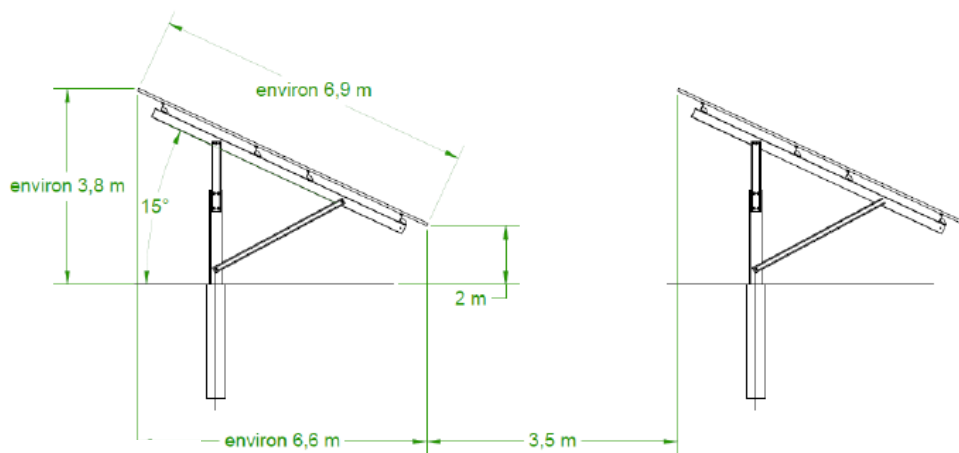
Plan de coupe des panneaux sur la partie pâtre (Source : ABOWIND)
